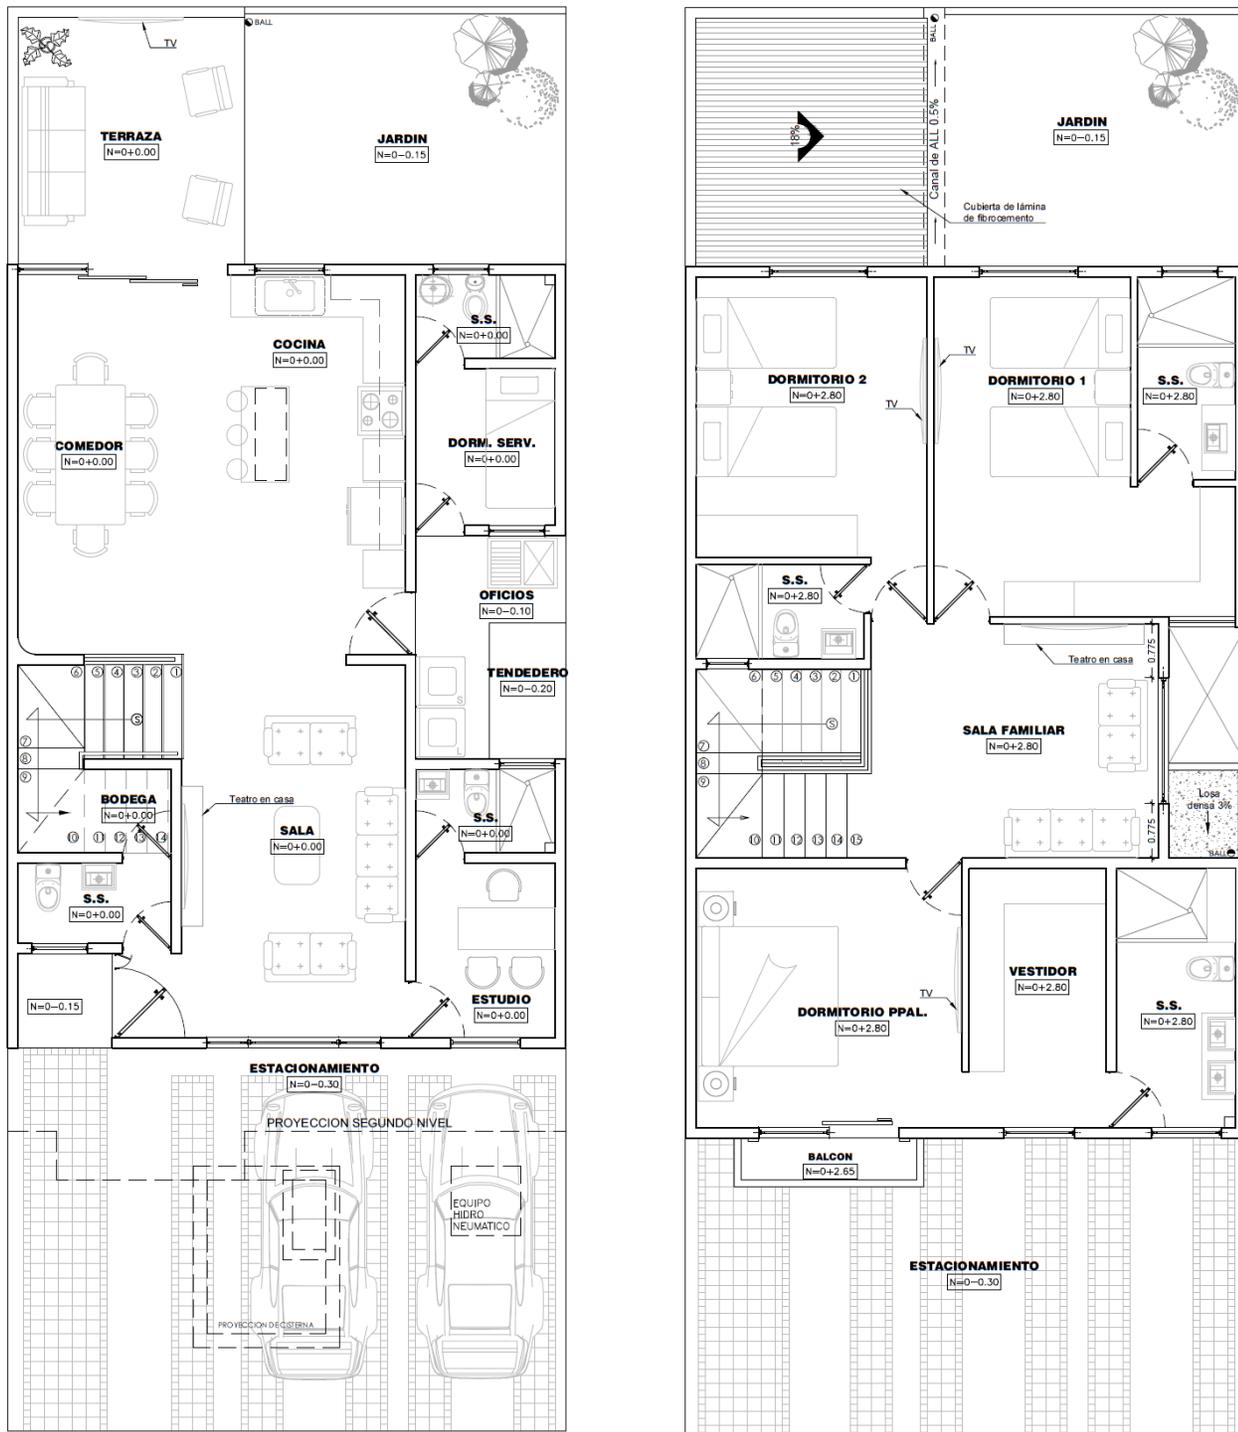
Plantas arquitectónicas casa tipo Verona
